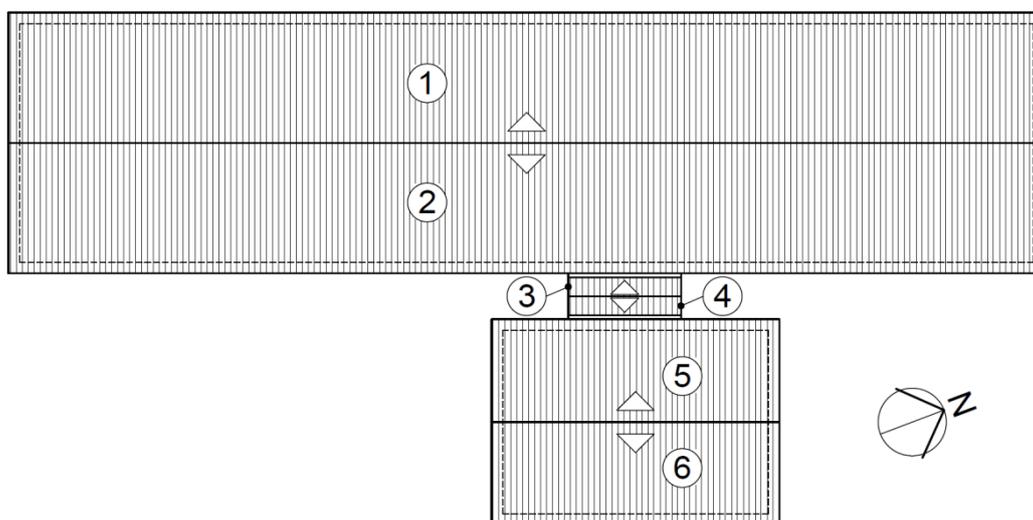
Cobertura do pavilhão de desenho e numeração das águas do telhado.
